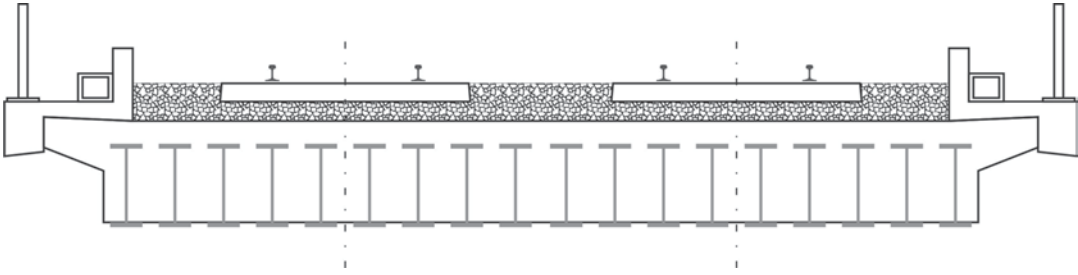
Verbundbrücke mit einbetonierten Stahlträgern
